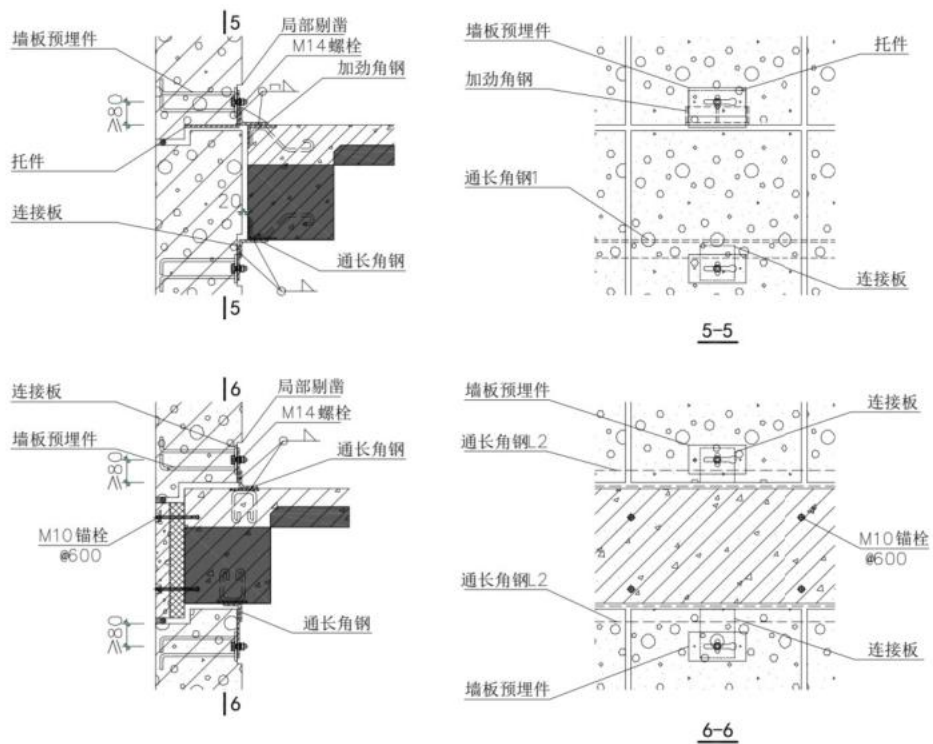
4 钢钢筋混凝土结构外墙墙板预埋式摇摆节点
